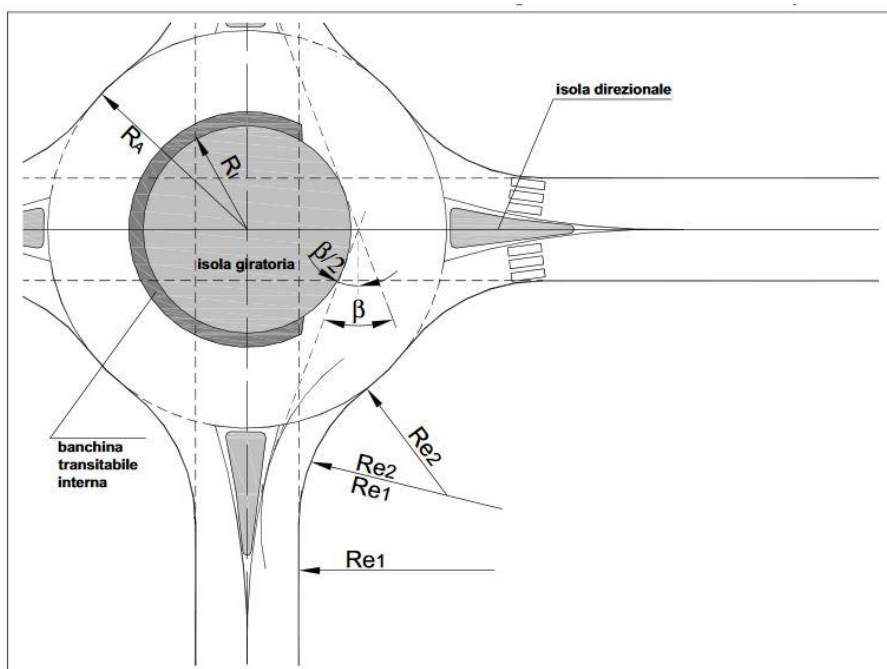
Elementi di progetto e tipizzazione delle rotonde
